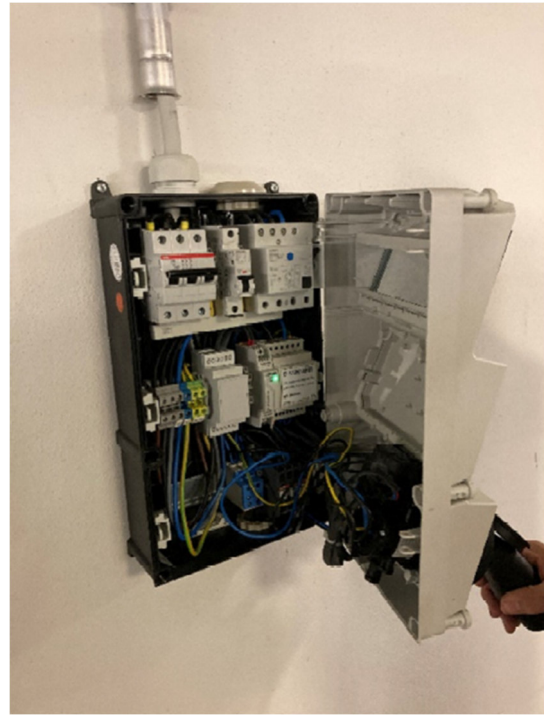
Ladestation offen (Besuchergarage B-2/222-224)
